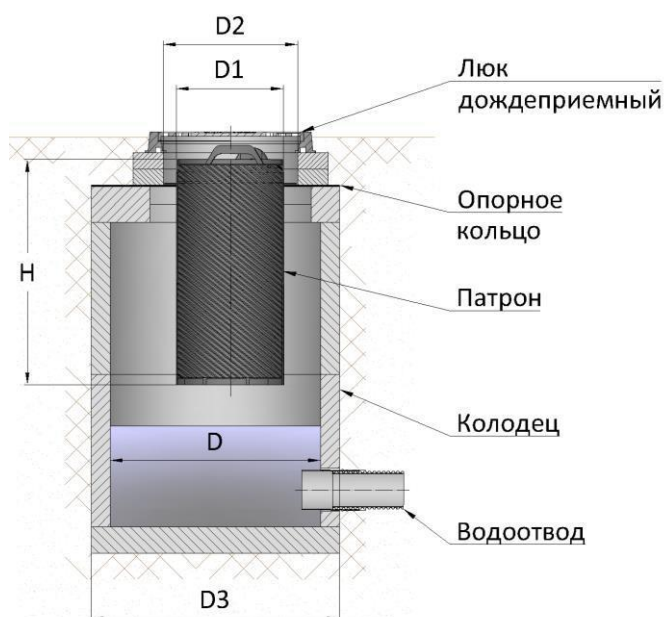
Габариты ливневого колодца и фильтрующего патрона
